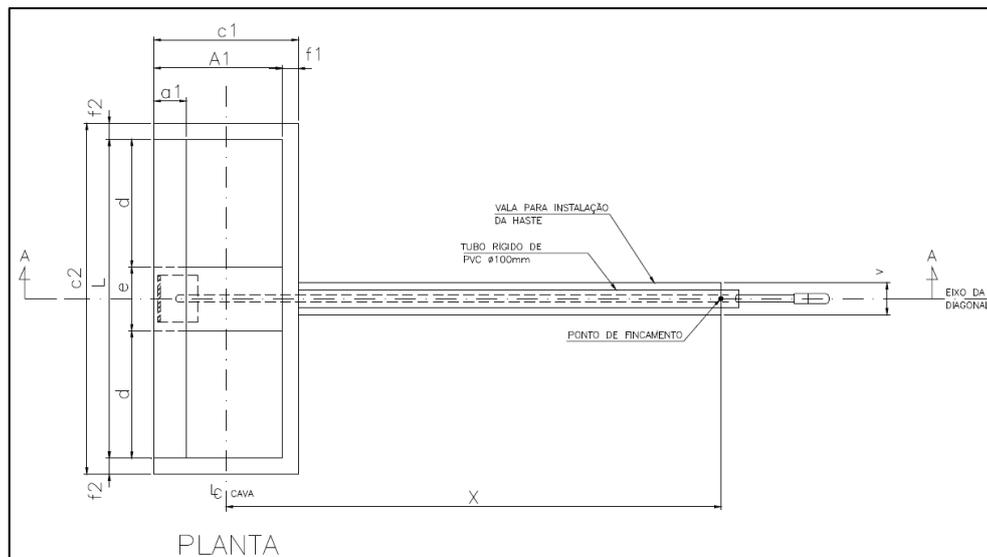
Viga pré-moldada para os estais com vista em planta.
